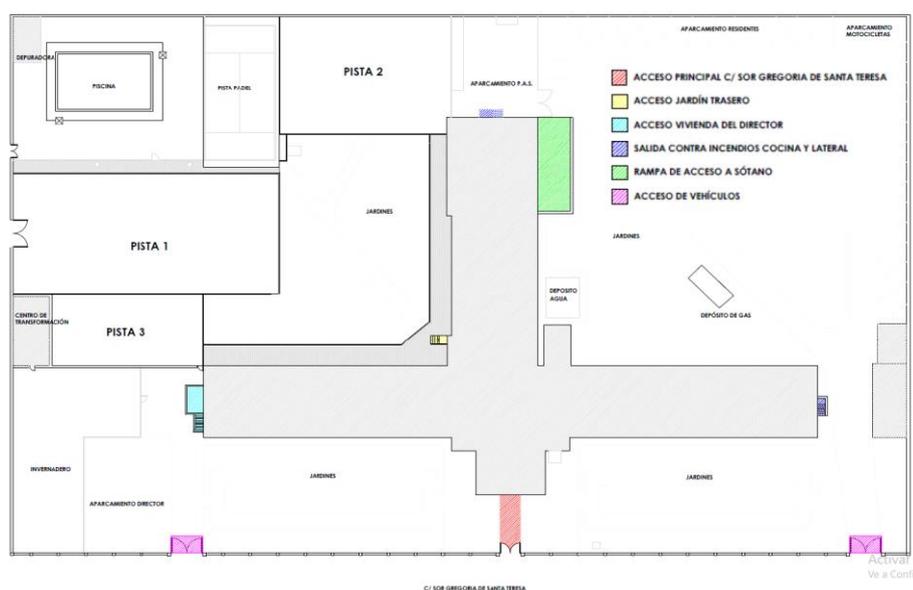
Plano de Accesos del colegio mayor Hernando Colón. Fuente: Archivo C.M.H.C.
